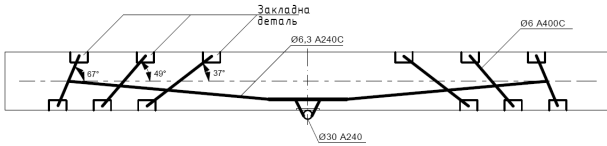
Схема підсилення балки БПС-II-1 поздовжньою і поперечною похило розташованою зовнішньою арматурою
